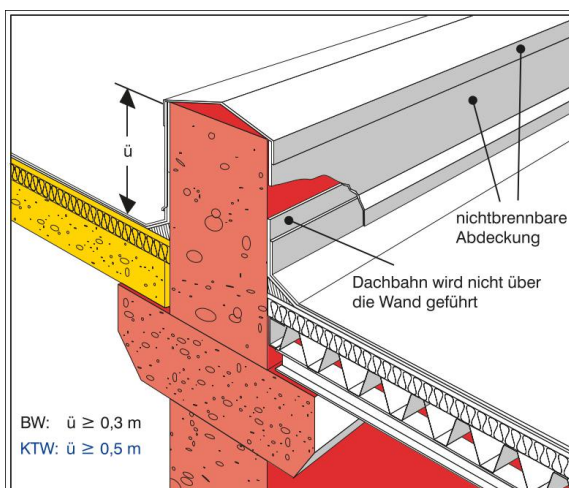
Wandanschluss bei nicht feuerbeständigem Dach mit brennbarer Dämmschicht oder brennbarer Dachhaut
